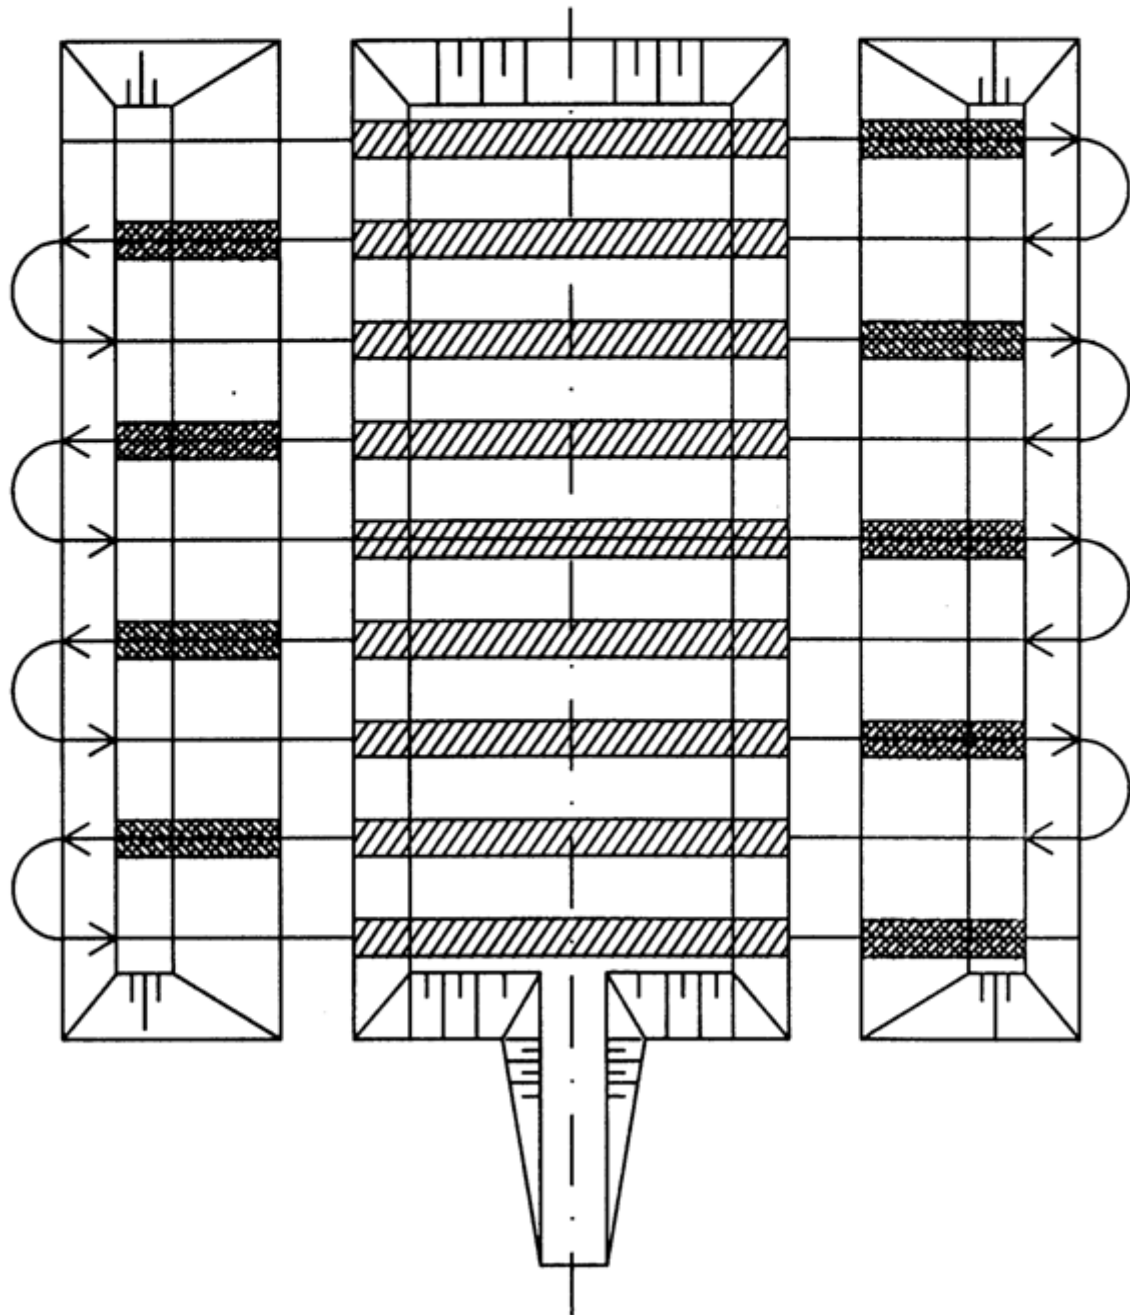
Схемы разработки грунта по вскрытию карьера бульдозером.
